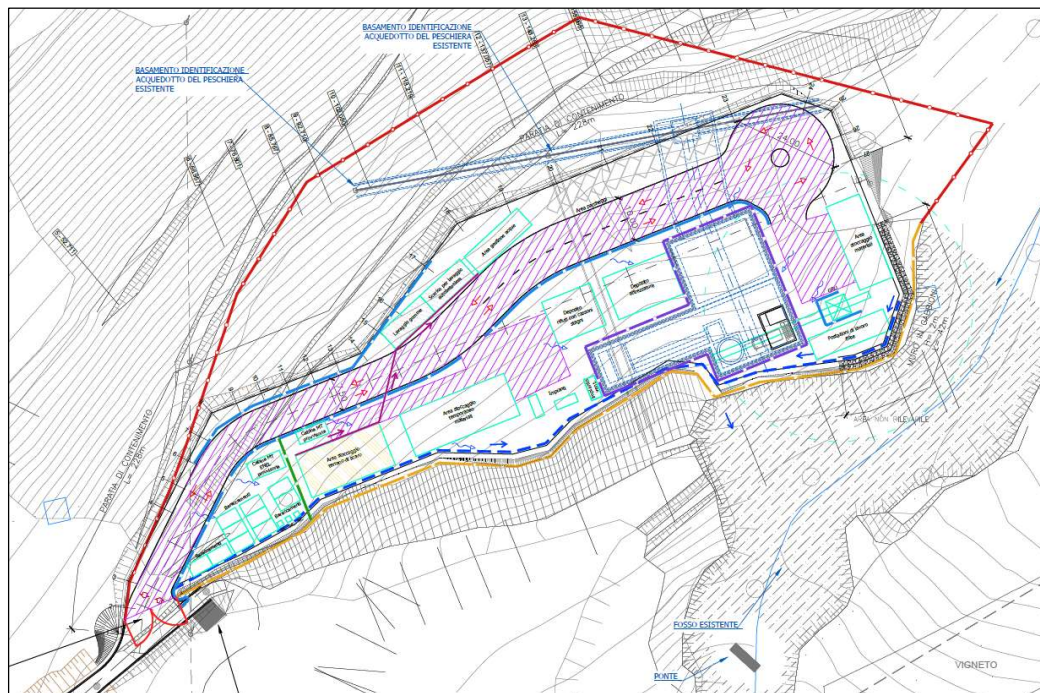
Area di cantiere allaccio al Peschiera Inferiore DX
